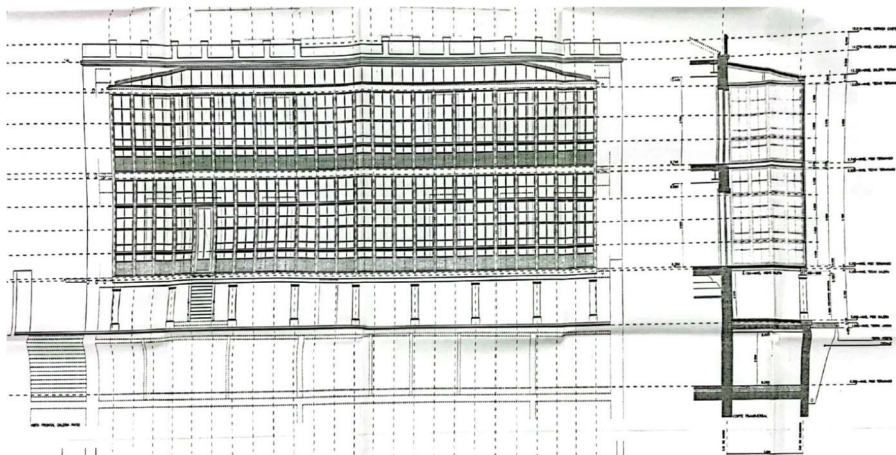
Plano 47 del estado modificado para la configuración de la nueva galería.
